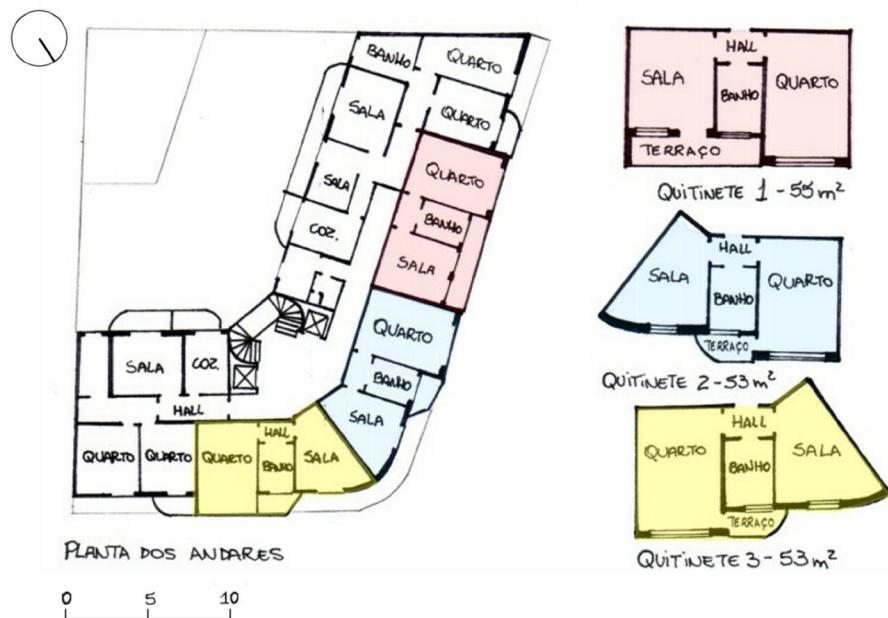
Reprodução da planta do Pavimento tipo do Edifício Lívia Maria.
